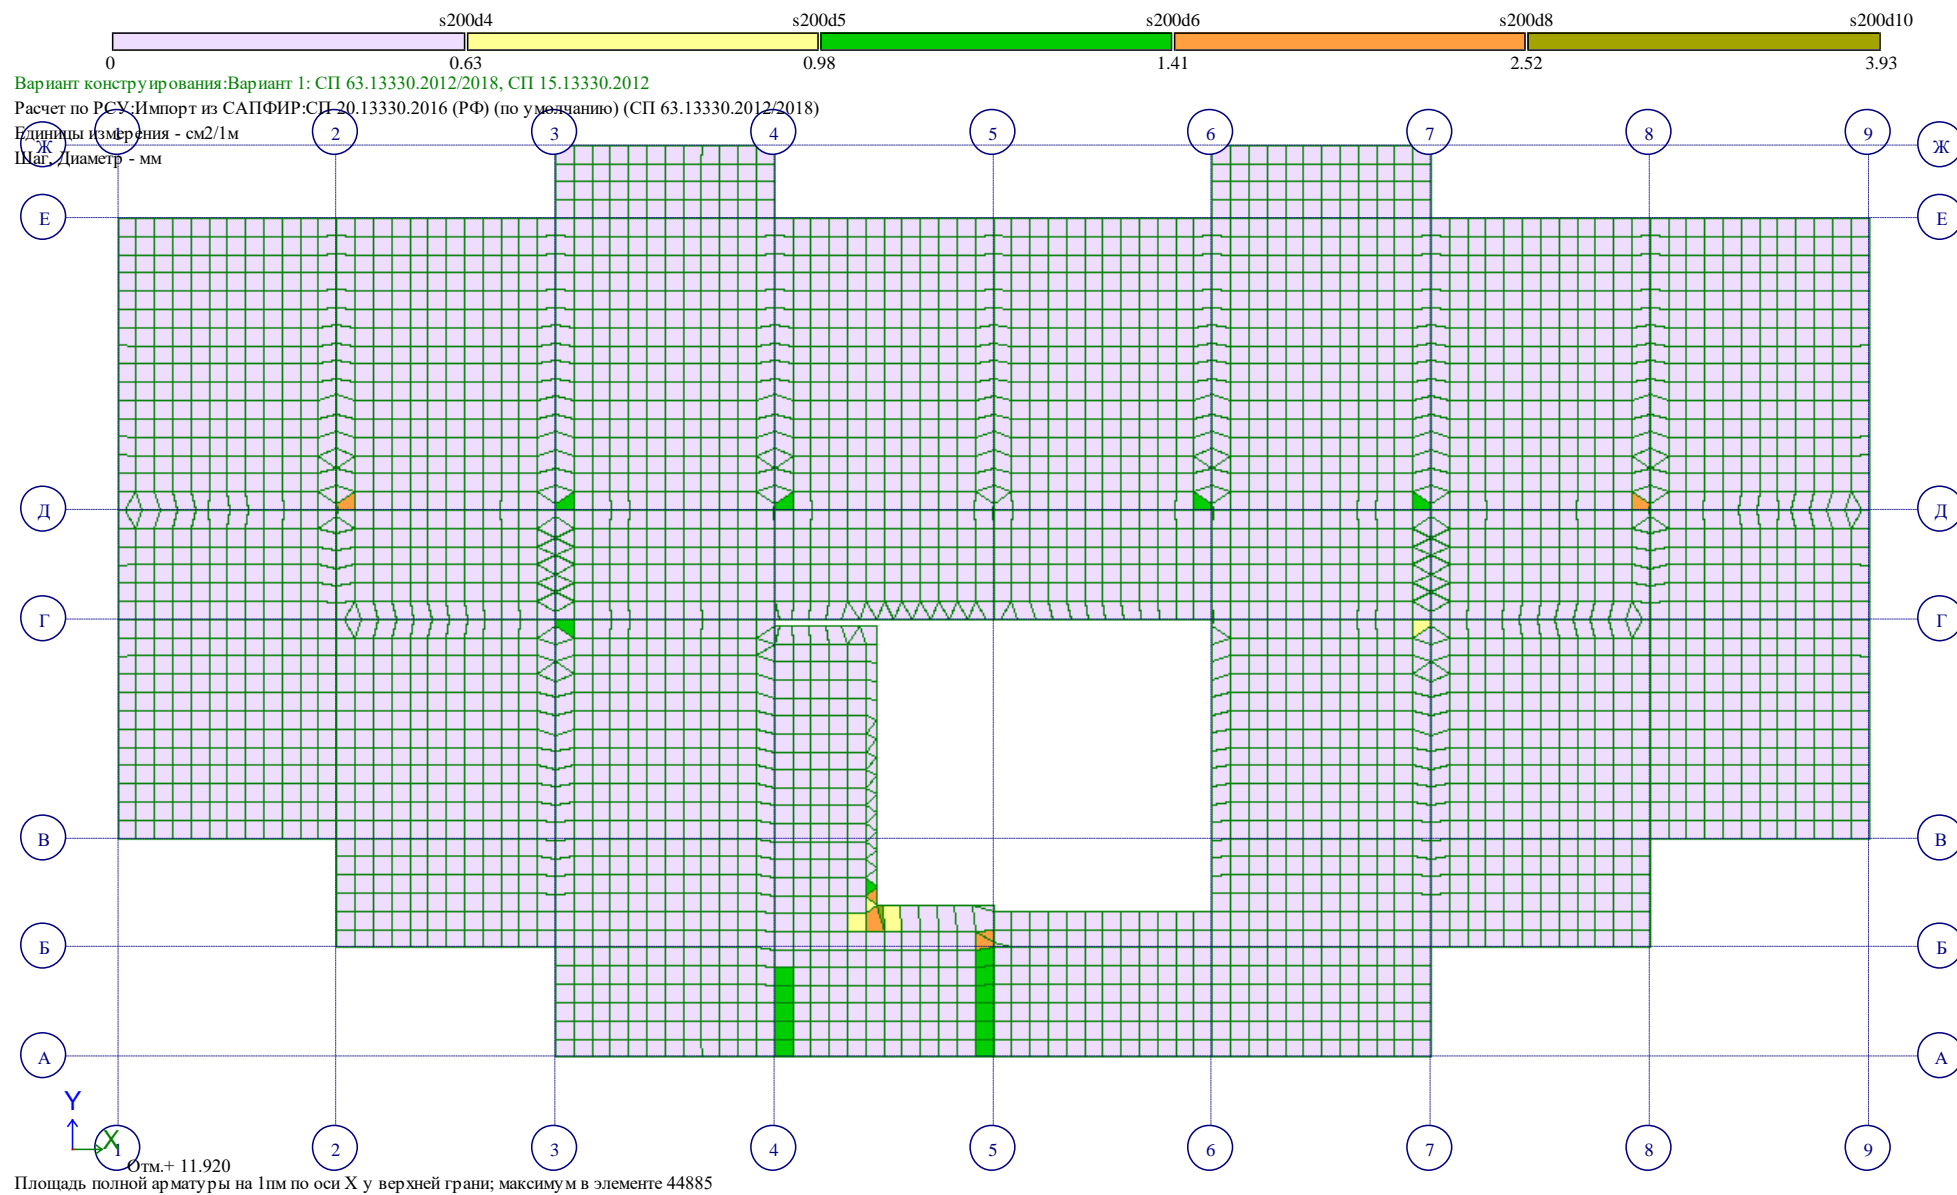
Площадь полной арматуры на 1мм по оси X у верхней грани
